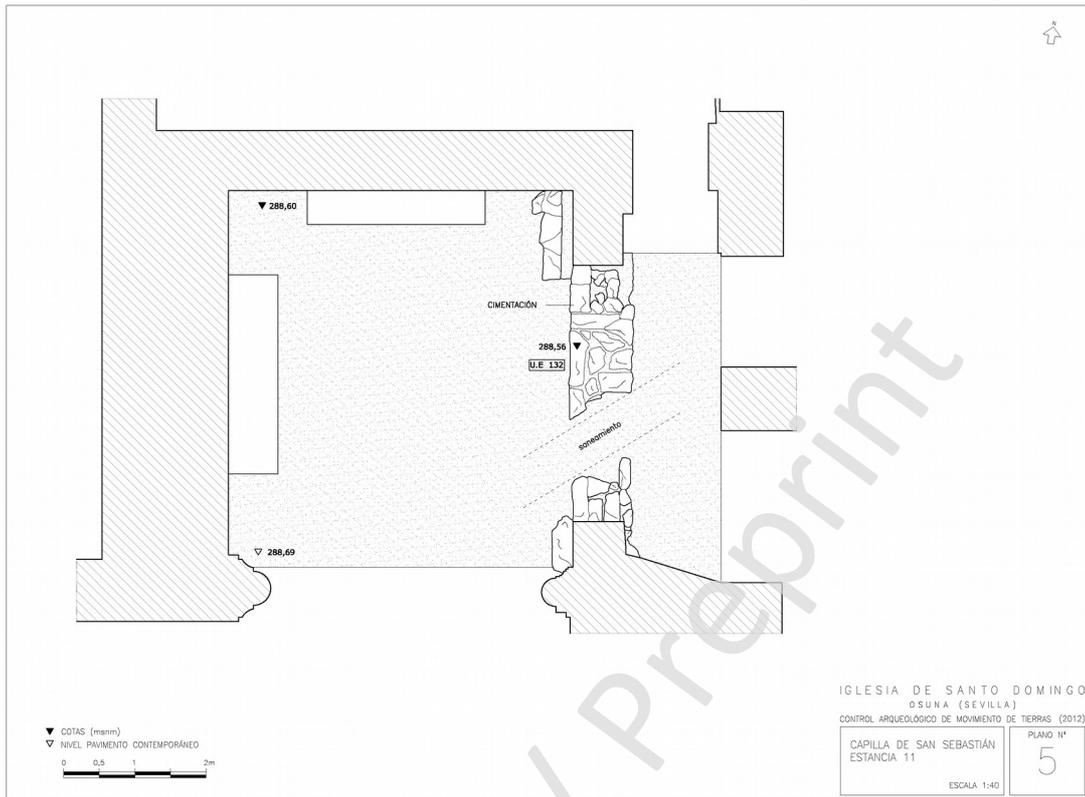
Plano con los restos correspondientes a la cimentación hallados en la Capilla de San Sebastián (Estancia 11)
